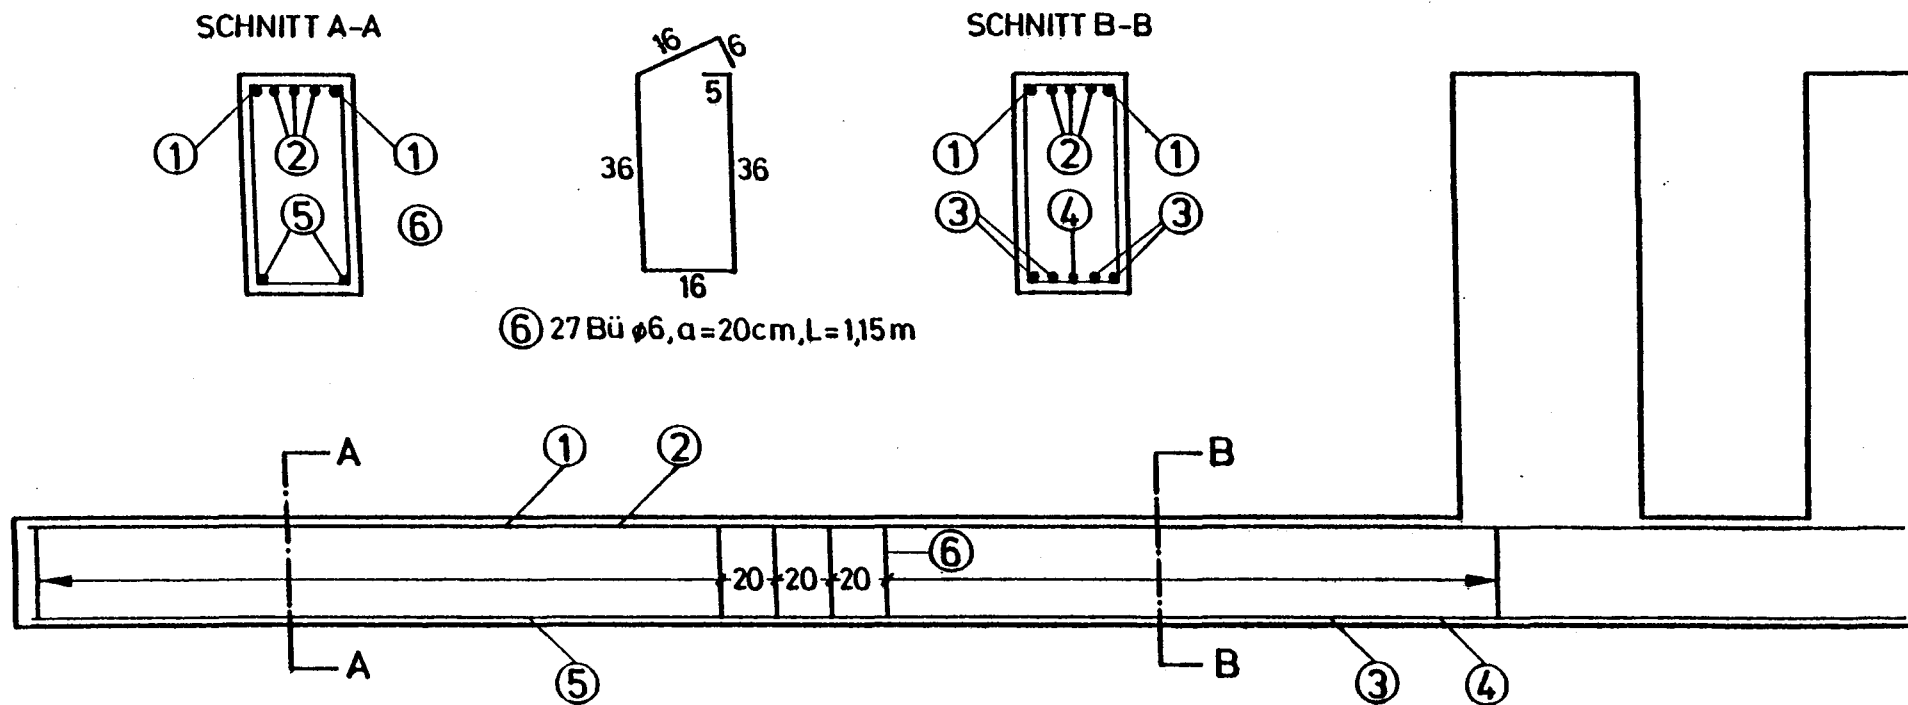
/2.1: Betonabmessungen der Kurzzeitbalken
